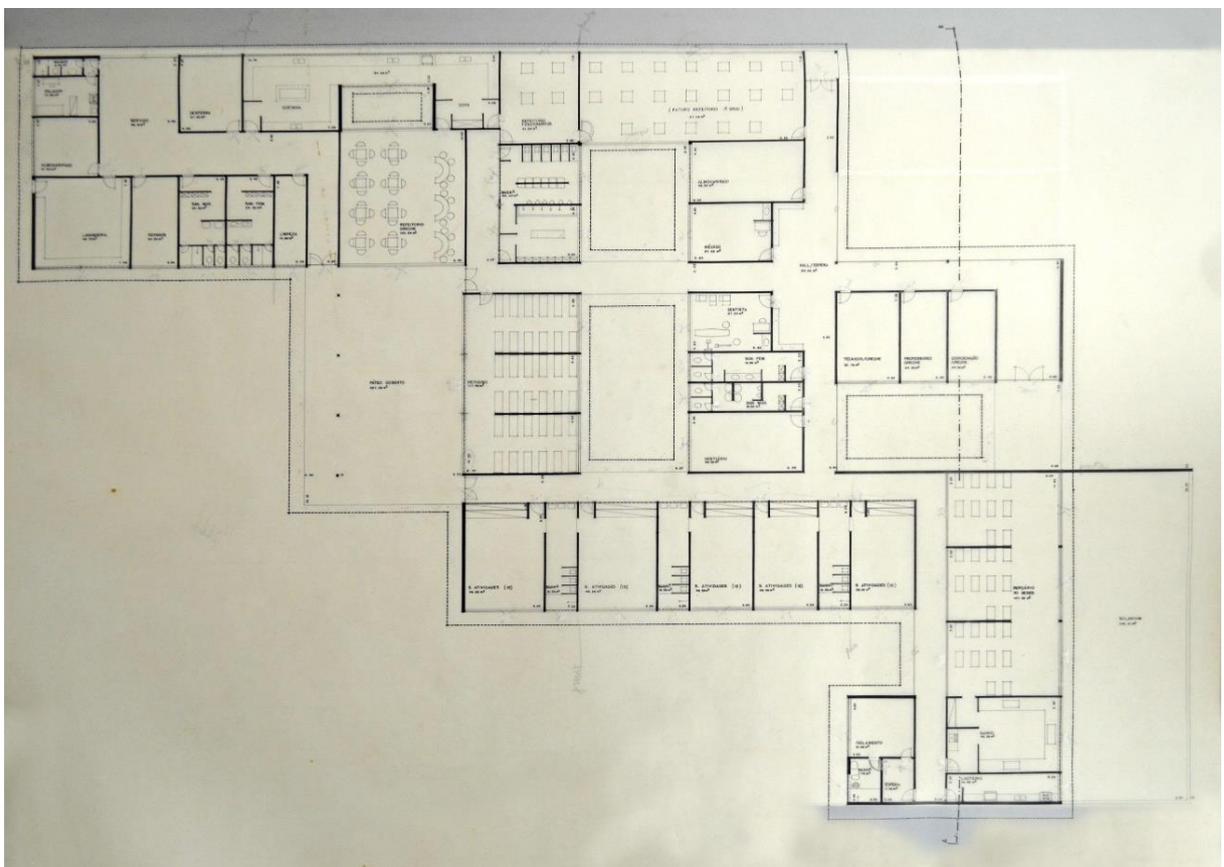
Planta-baixa bloco Creche, proposta de abril de 1982.
